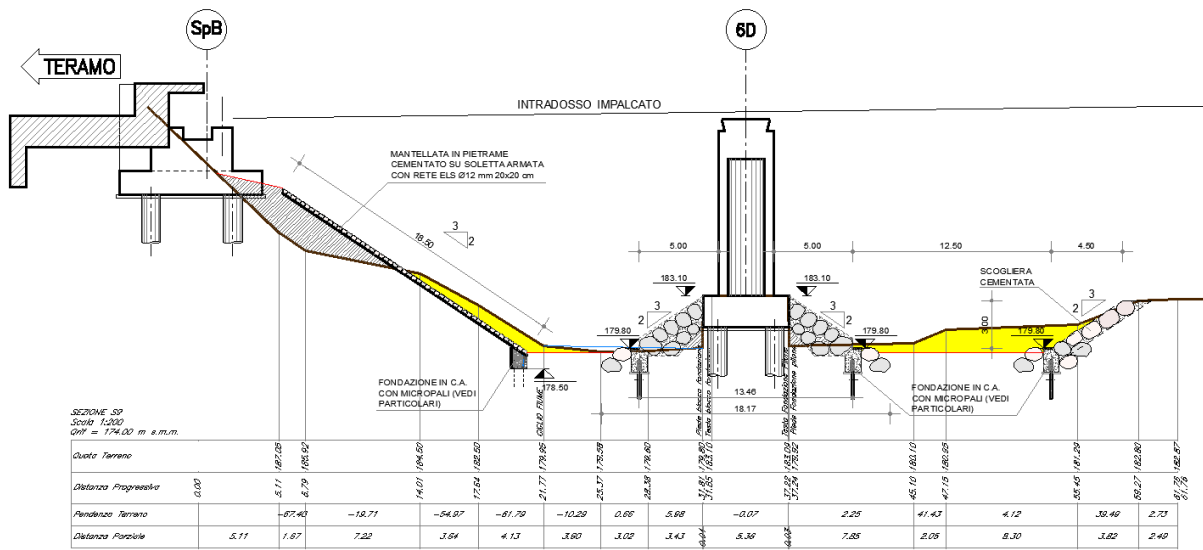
Sezione trasversale primo progetto (rel. 2018)
